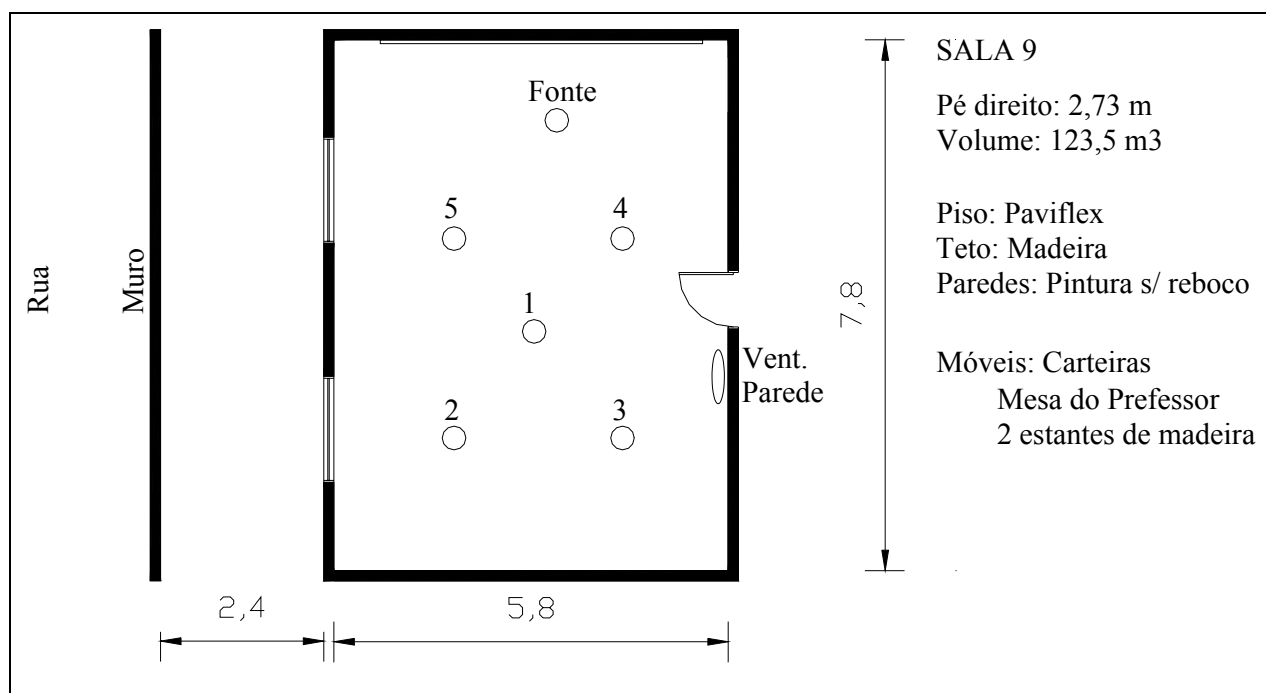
Planta baixa com localização dos pontos de medição da sala de aula nº 9.
